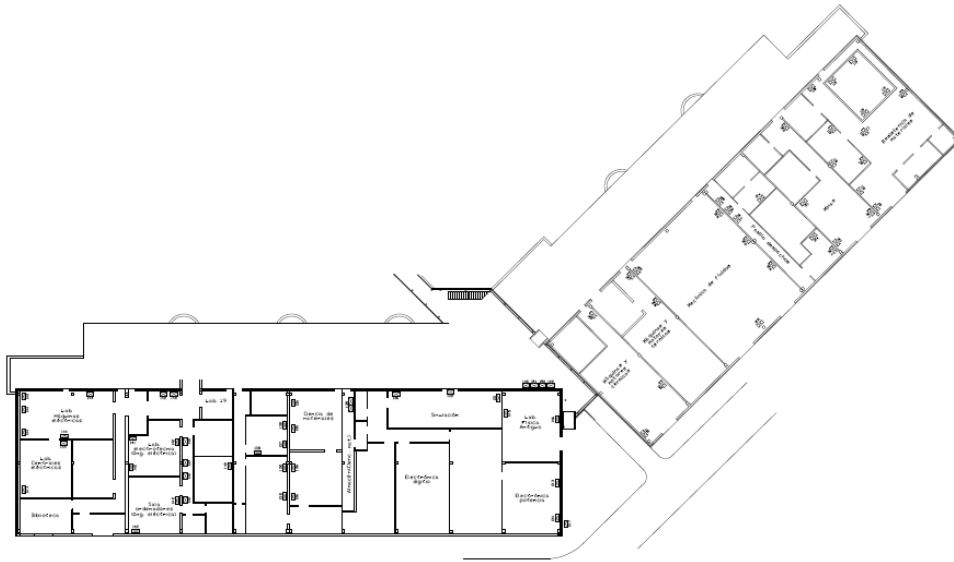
Vista en planta de los espacios en la actual ETSII (Edificio II – Zona IV)
